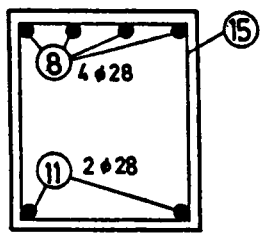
Bewehrung der Versuchskörper B V und B VI
